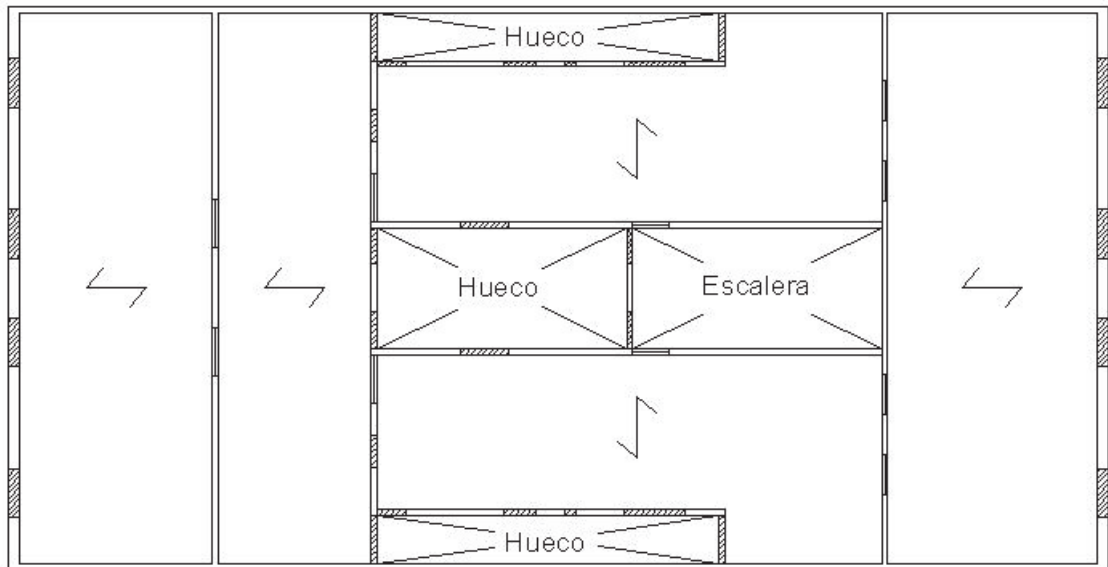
Direcciones de carga de los forjados en planta tipo.
